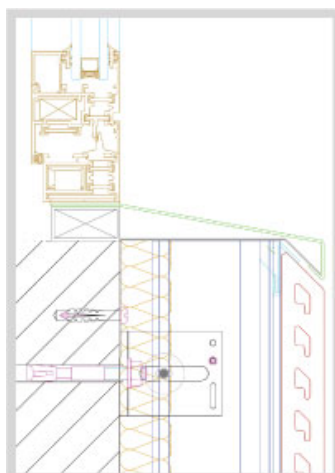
Aplicação da fachada ventilada – Janela – secção vertical inferior [47]
